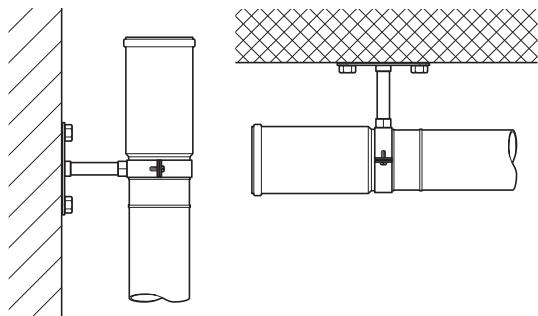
Fixation verticale et horizontale par point fixe avec collier sur le manchon long Geberit HDPE
